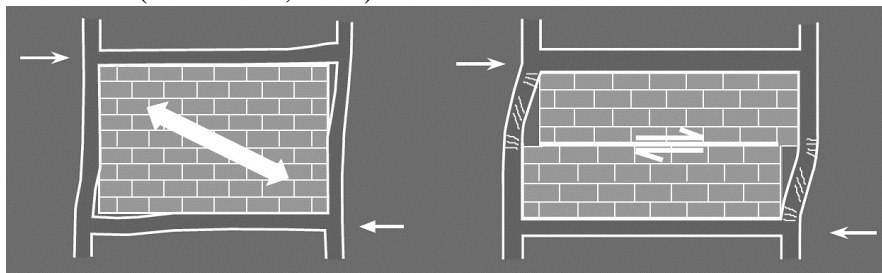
Consecuencia de arriostrar pórticos con muros de mampostería no estructural (Bachmann, 2003).
